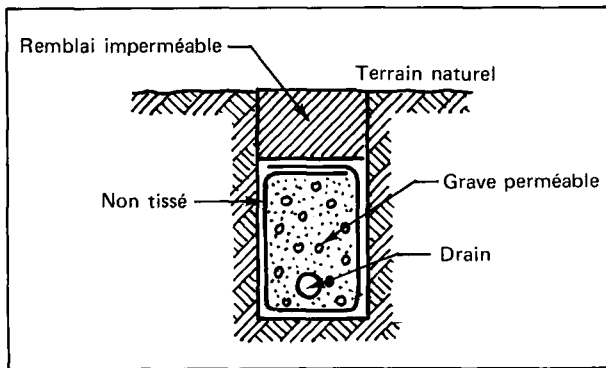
Coupe d'une tranchée drainante (avec emploi d'un non-tissé).
